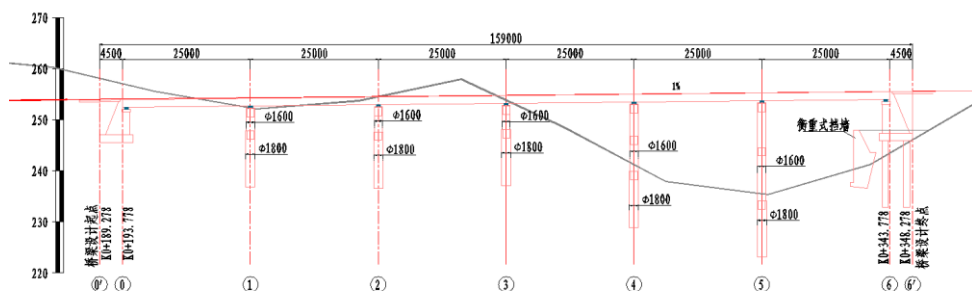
滨山大道高架桥右幅桥型布置图 (单位: mm)
